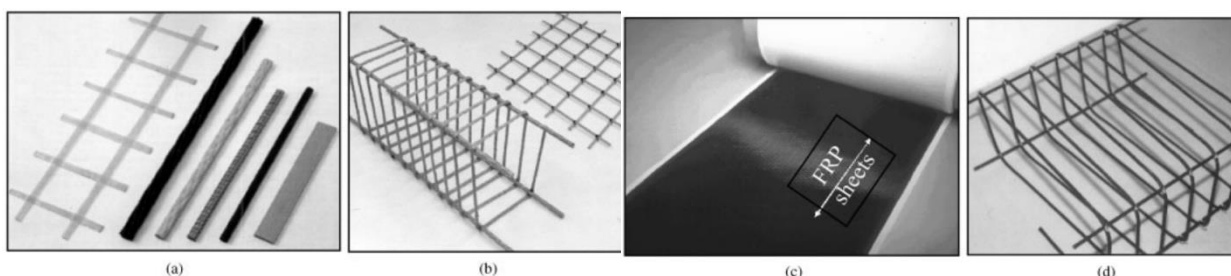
Produtos FRP para construções em betão armado: a) varões; b) armaduras de flexão e corte; c) laminados; e d) “gaiolas” (retirado de Rizkalla, Hassan e Hassan [43])
